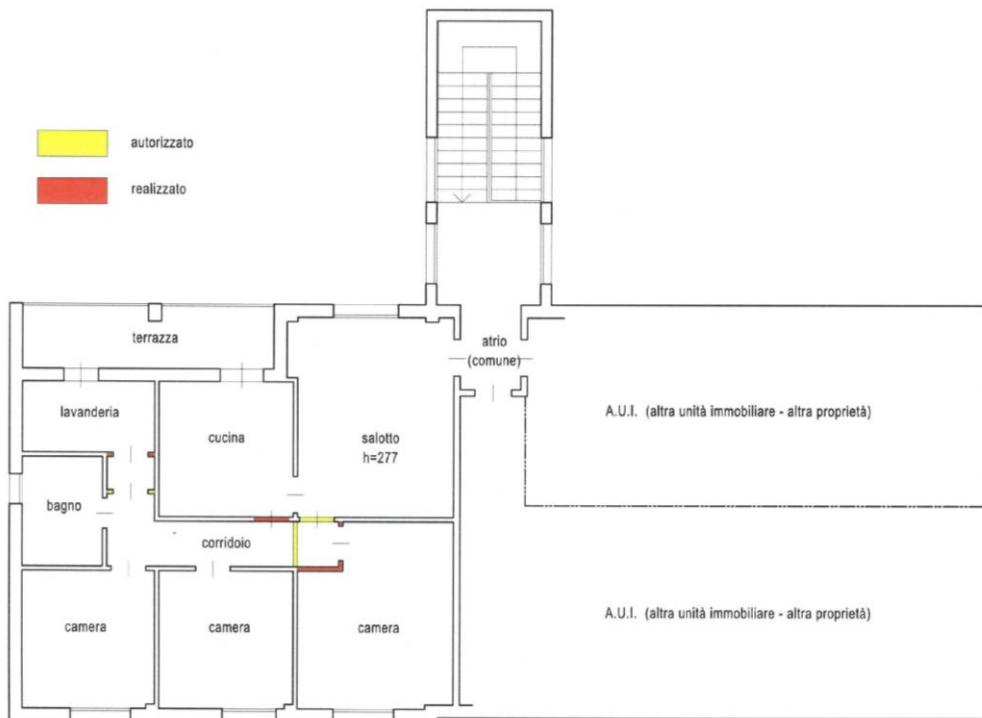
Sovrapposizione stato autorizzato/realizzato - Pianta piano secondo ([Allegato 10](#))
